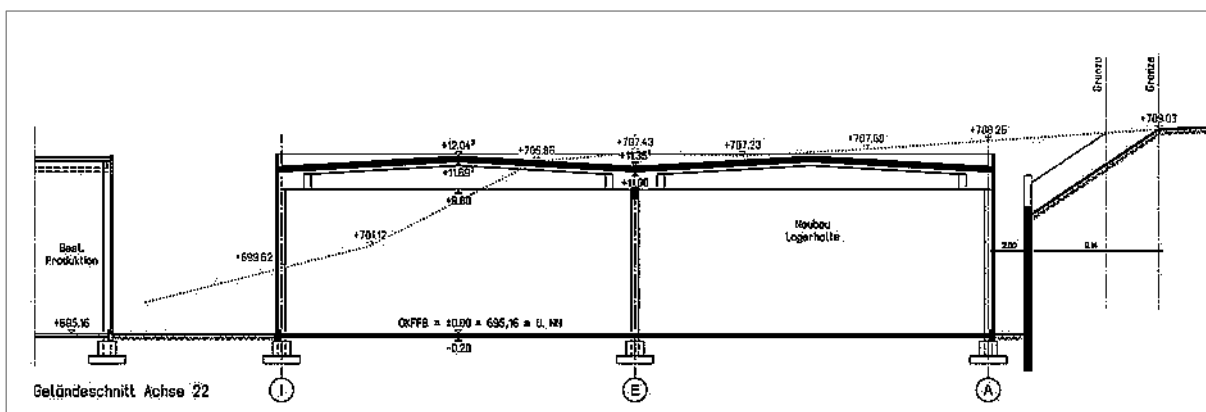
geplanter Geländeschnitt im östlichen Bereich der Lagerhalle (rot: bestehendes Gelände)
